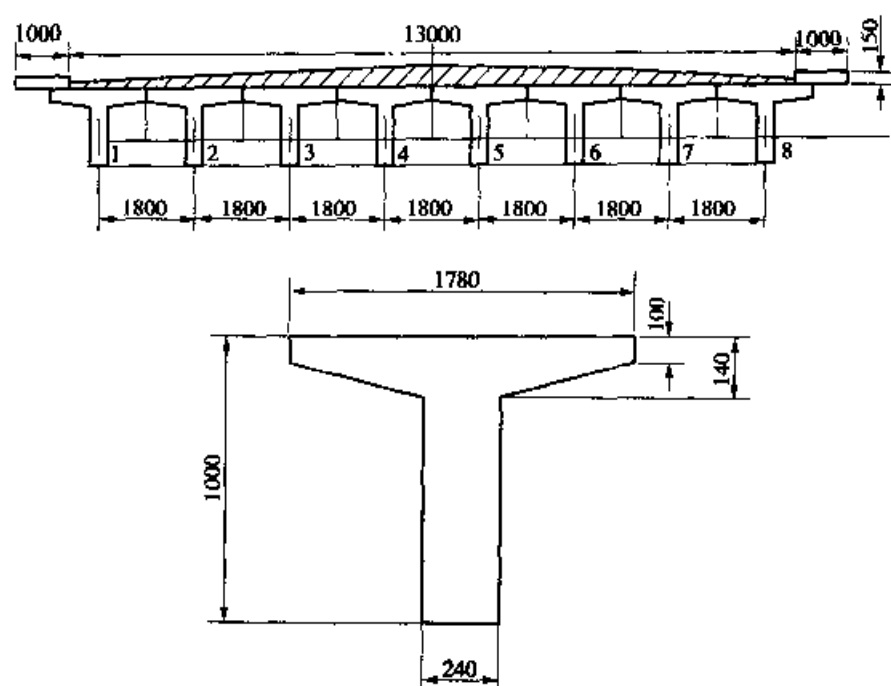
T 梁横断面尺寸(尺寸单位:mm)
